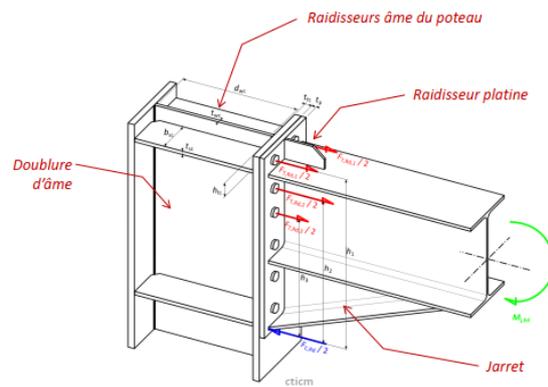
Assemblage poteau poutre métallique. Source : JT COTITA RENFORCEMENT PARASISMIQUE, STRUCTURES MÉTALLIQUES. P13
